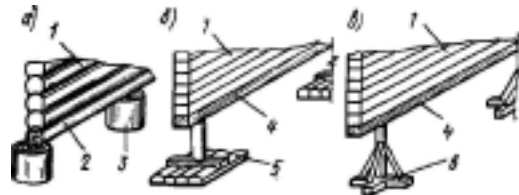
Конструктивные схемы столбчатых деревянных фундаментов:
